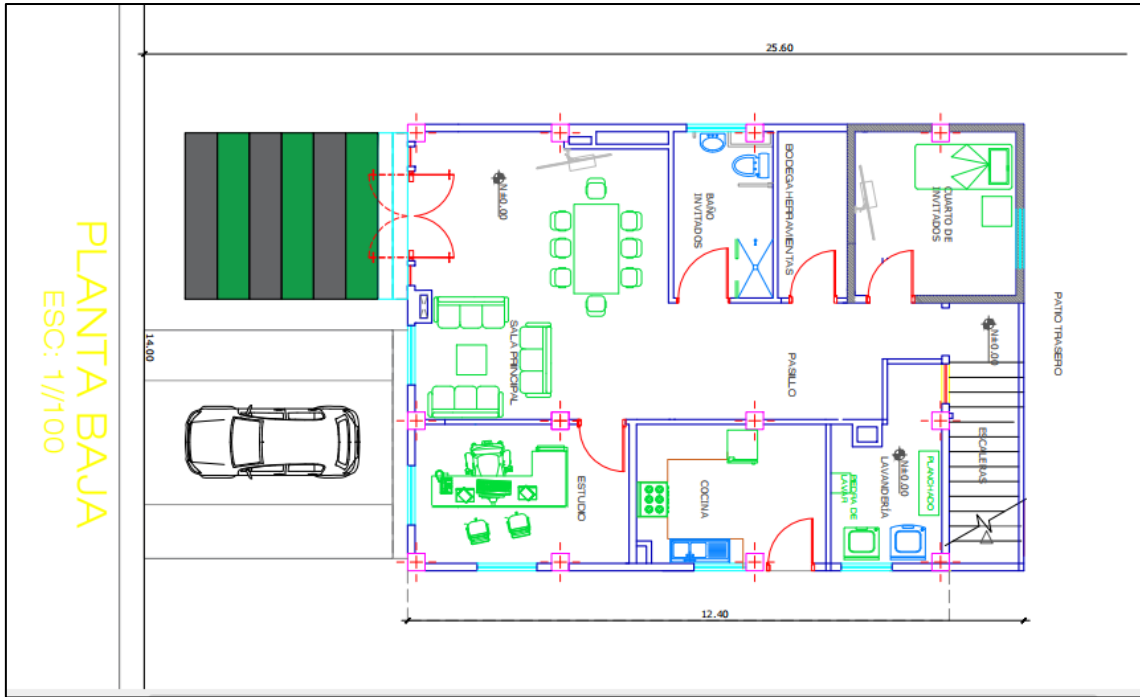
Plano arquitectónico de Planta Baja de la vivienda (Escala 1/100)
